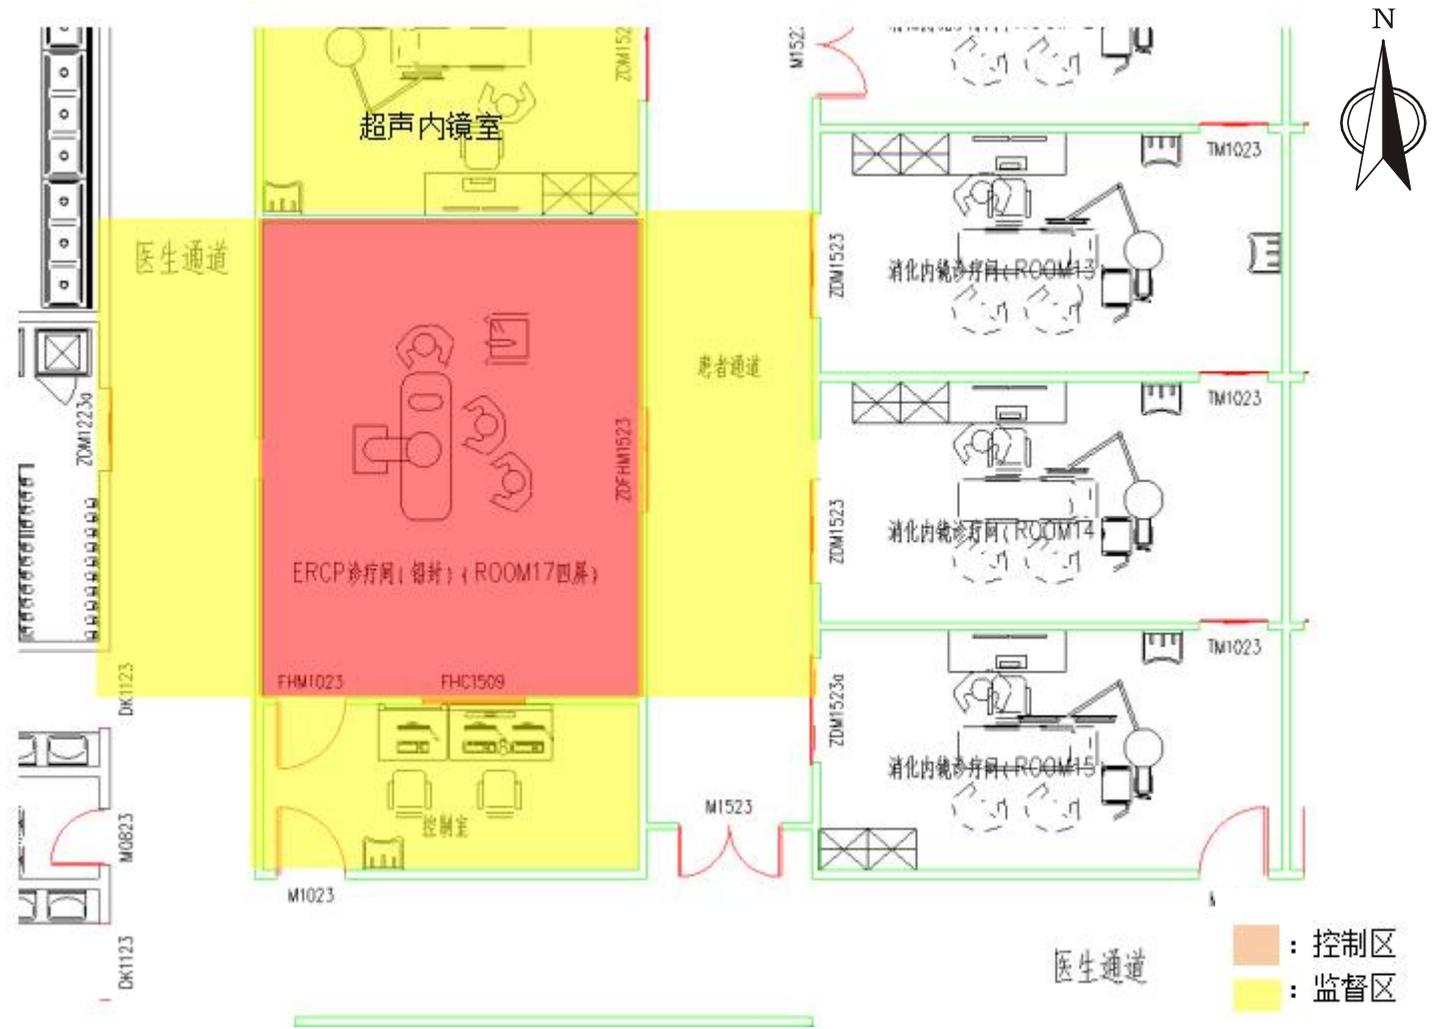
中心院区门诊医技楼二层平面布置示意图（局部）及分区图
